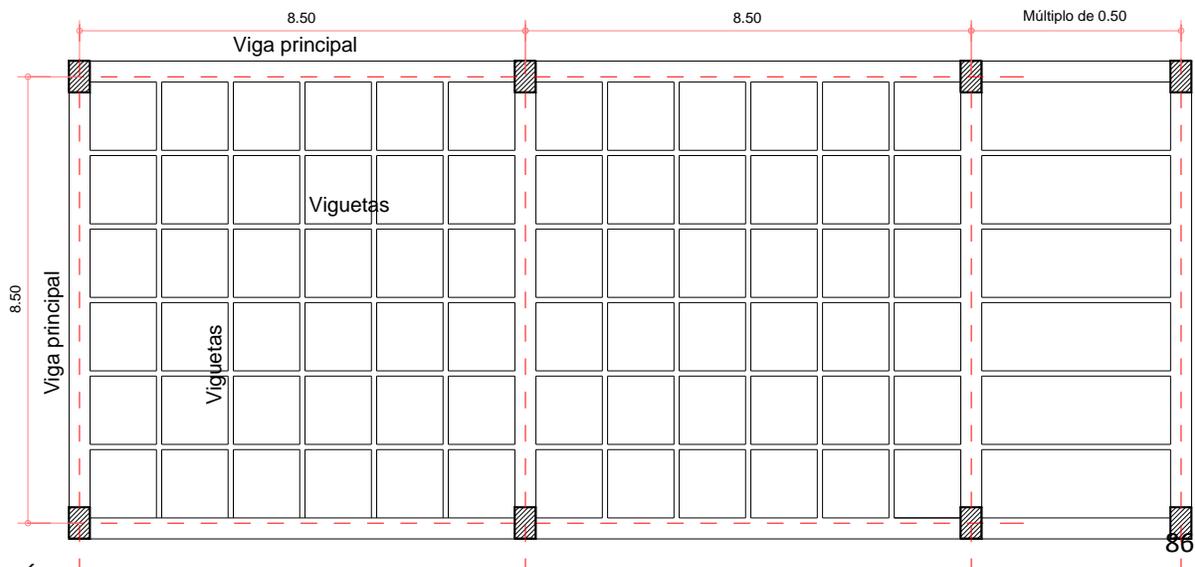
Propuesta sistema de entrepiso en concreto reforzado. Combinación de entrepiso armado en una dirección y en dos direcciones
